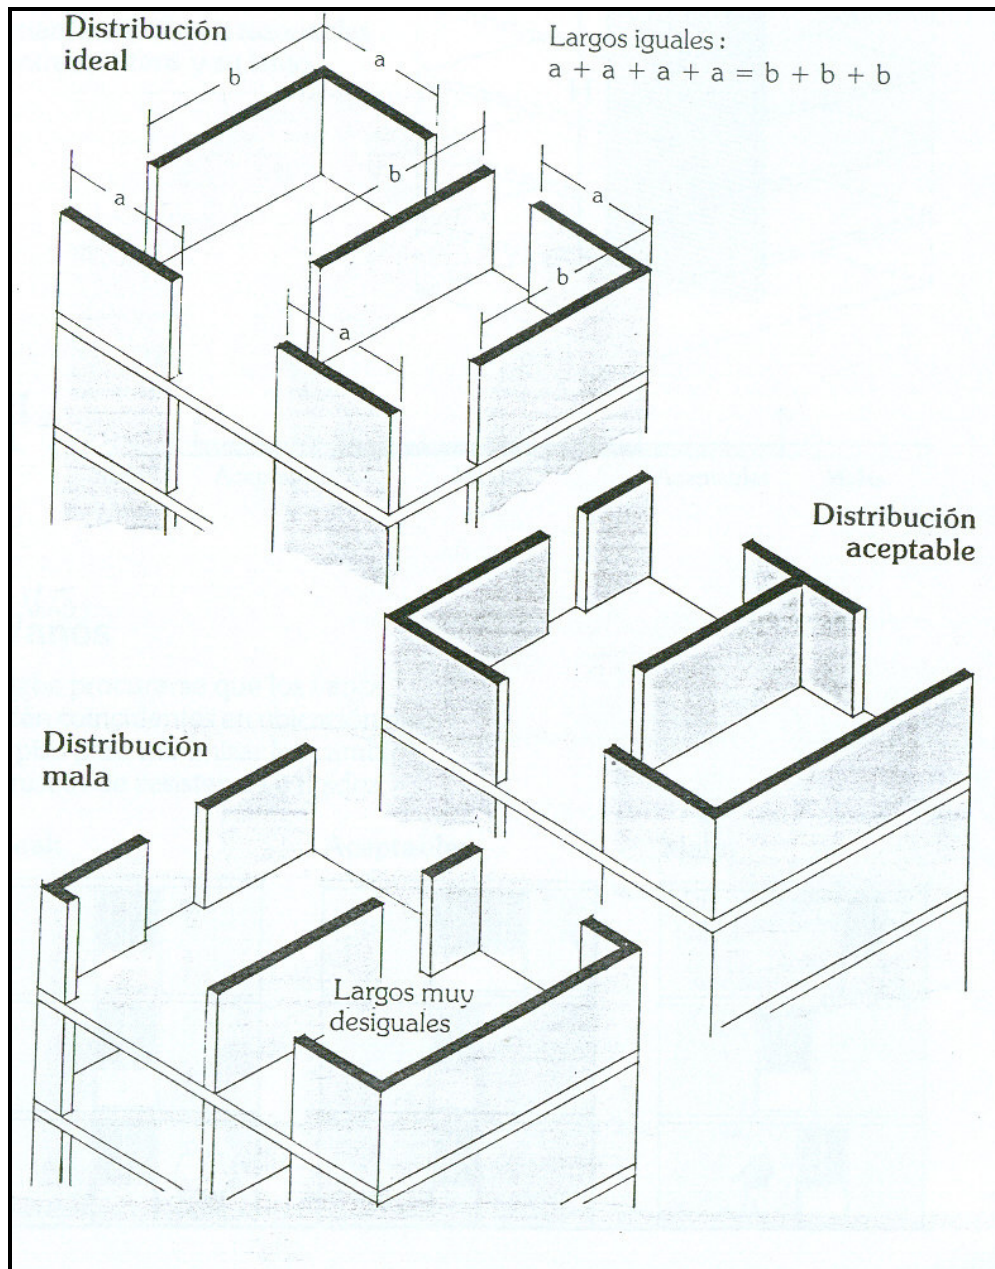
Distribuição das paredes ao longo da planta (VARGAS, 1987).
